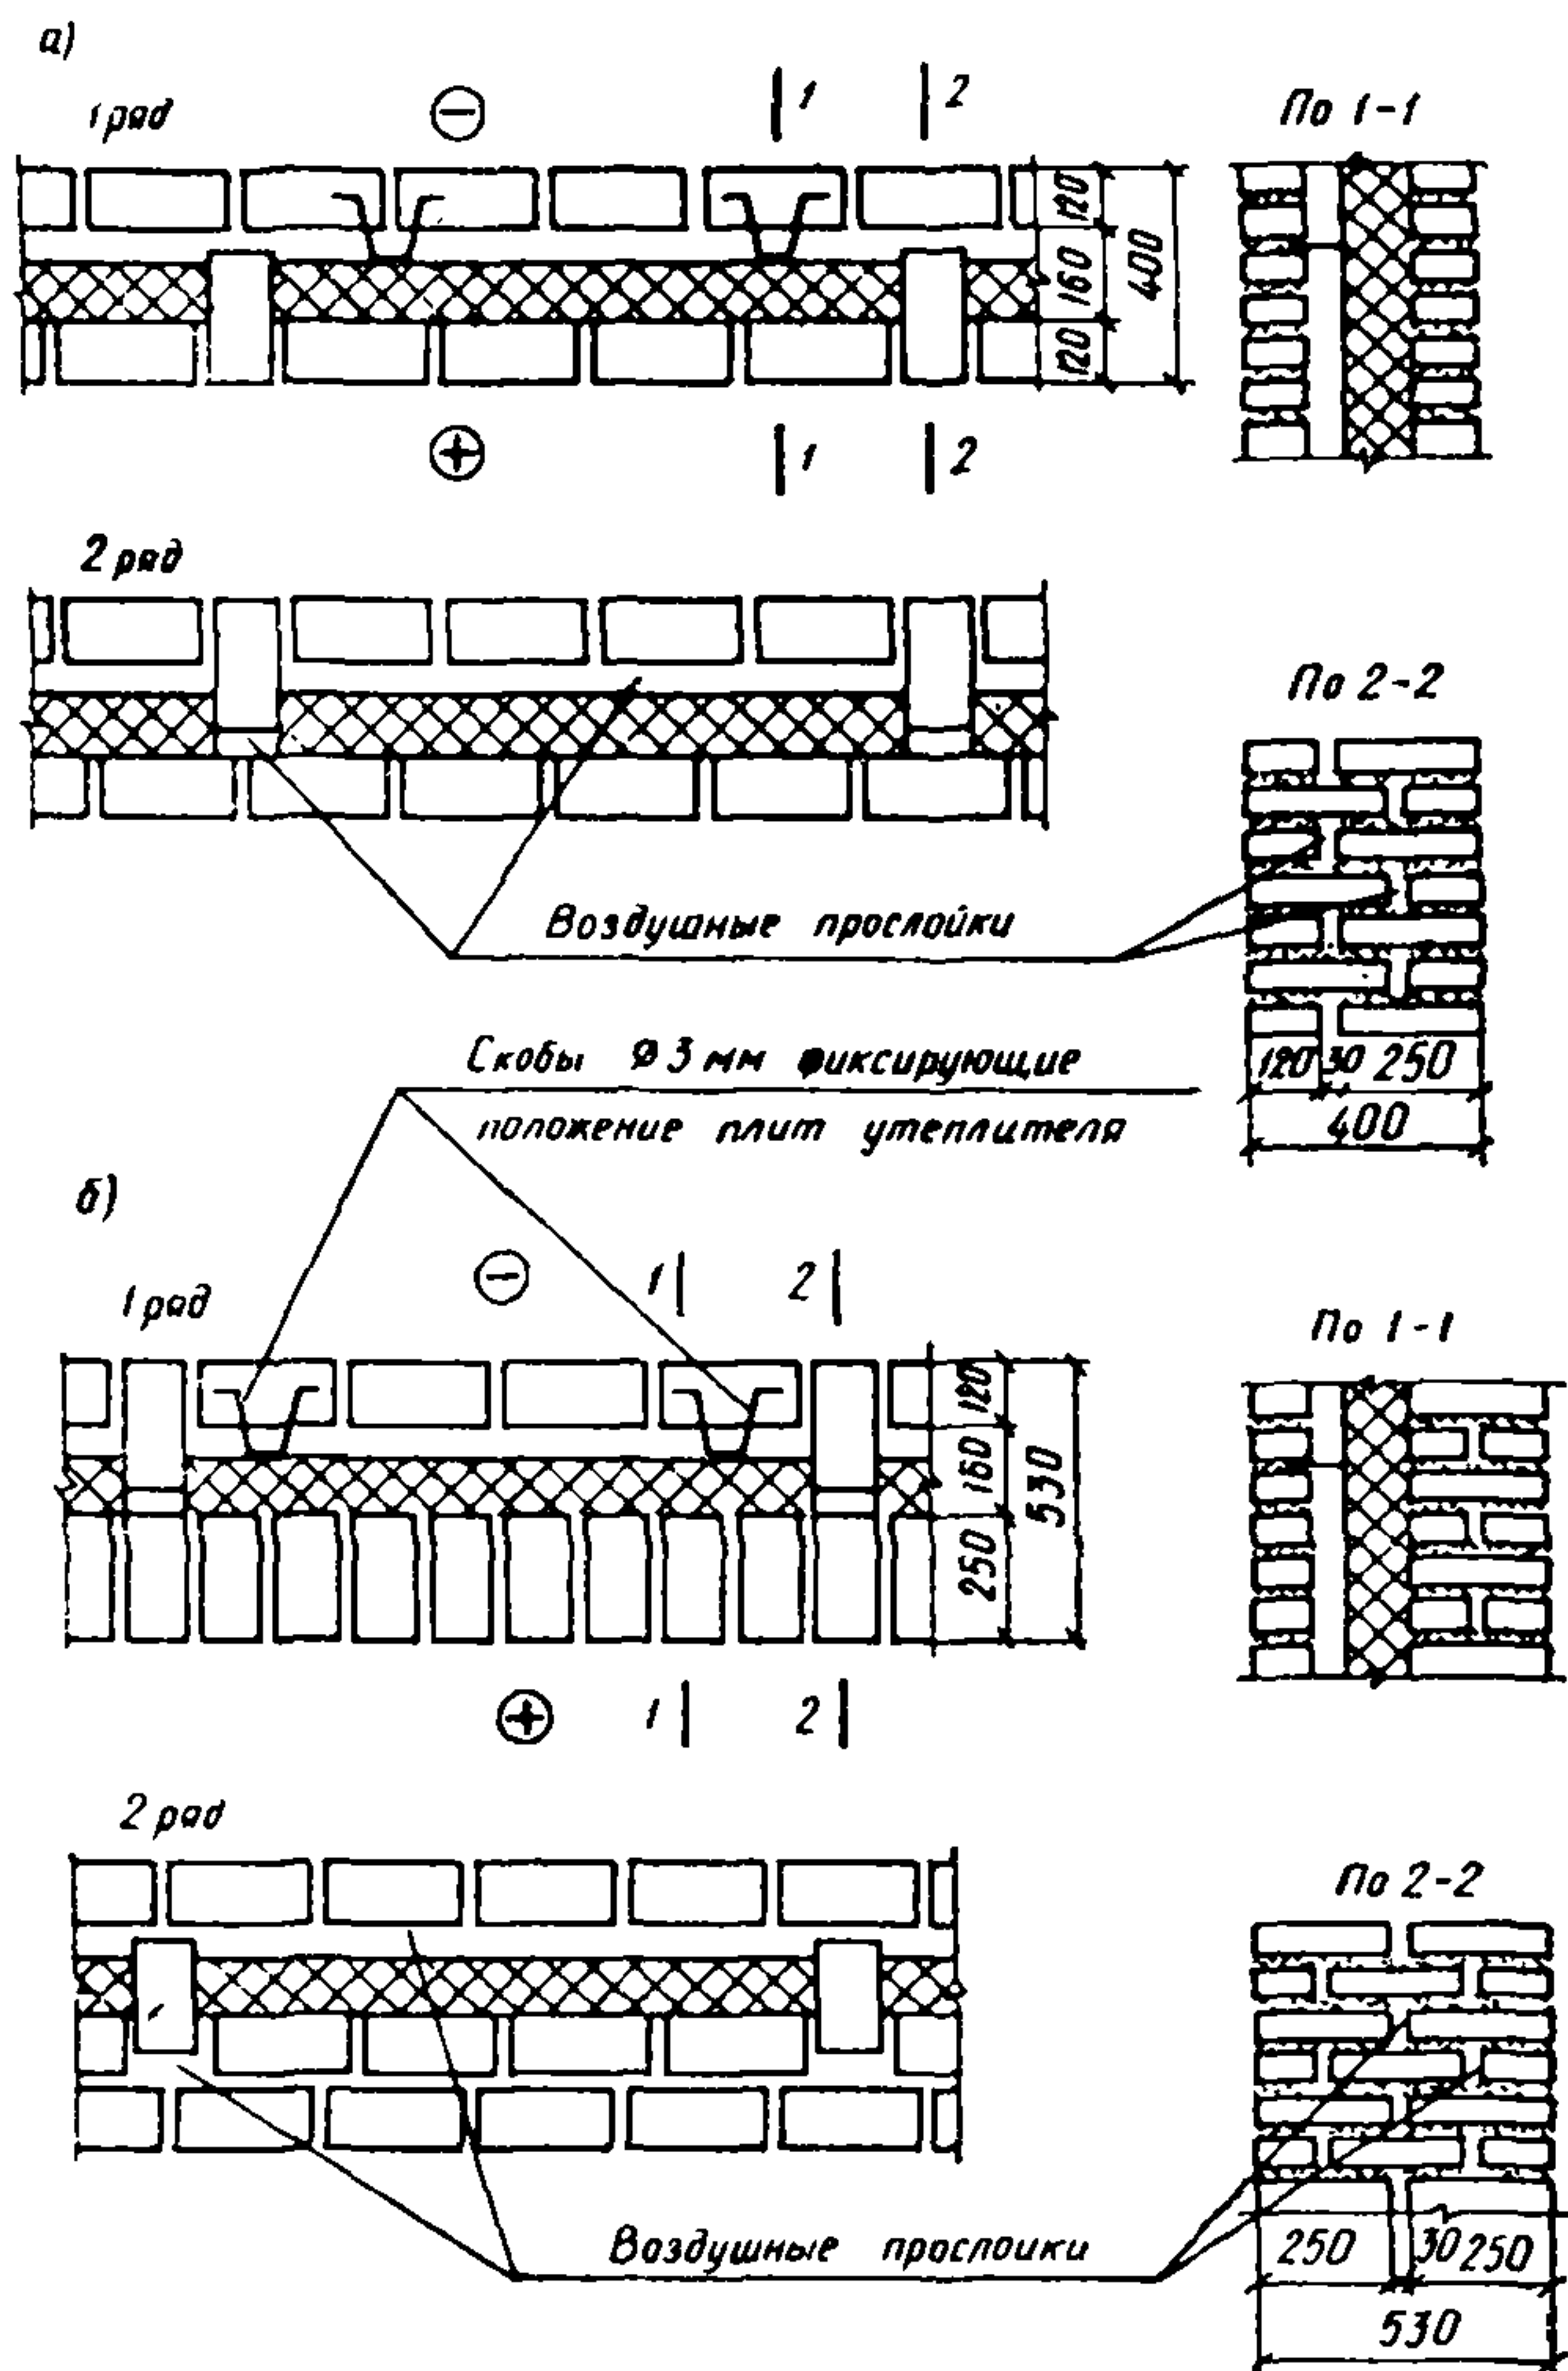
Кладка типа VII кирпичная с вертикальными поперечными стенками, плитным утеплителем и воздушным прослойком
